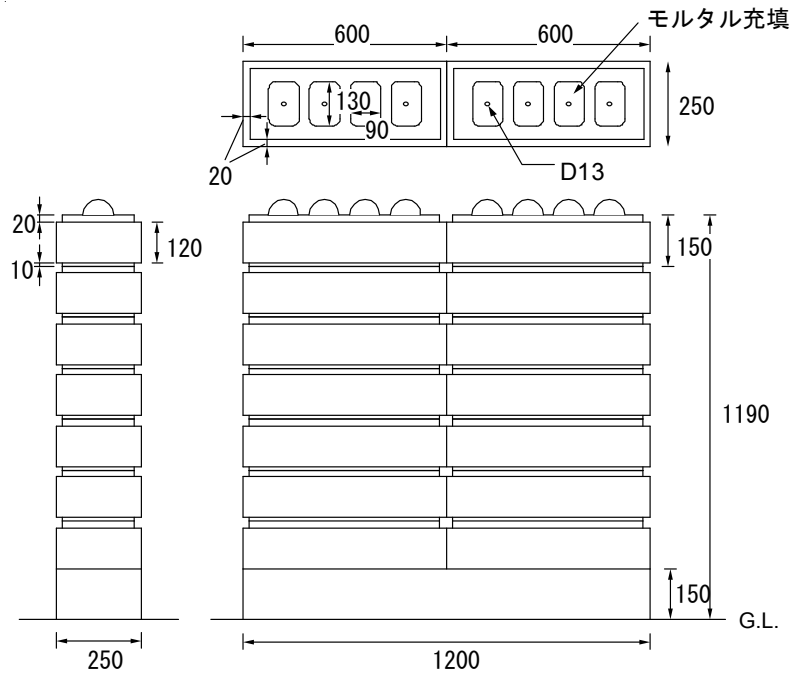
S 製作所 CB 塀伏図・立面図（単位：mm）
